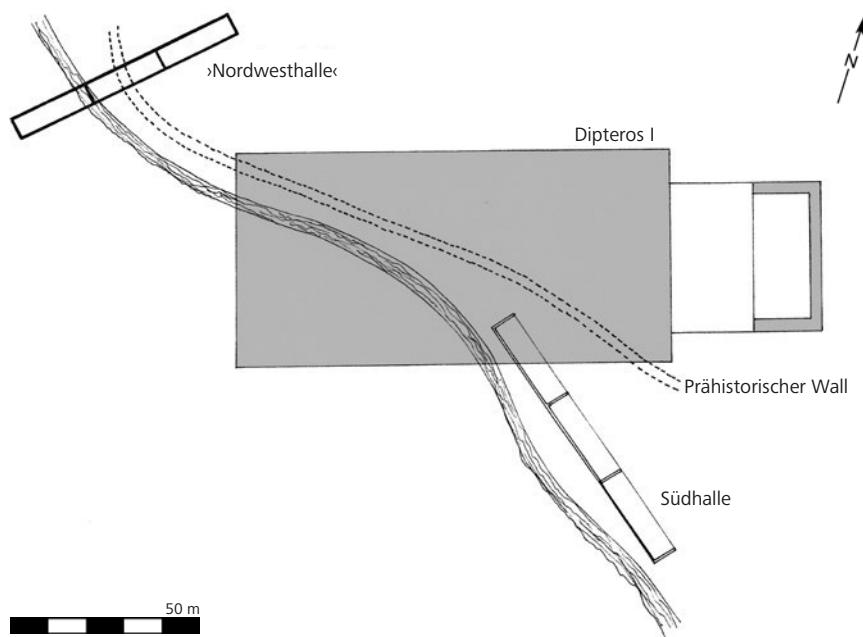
Der Verlauf des Imbrasosarmes mit Prähistorischem Wall, Südhalle, Dipteros I und Grundriss der ›Nordwesthalle‹ (M. 1 : 2000)
